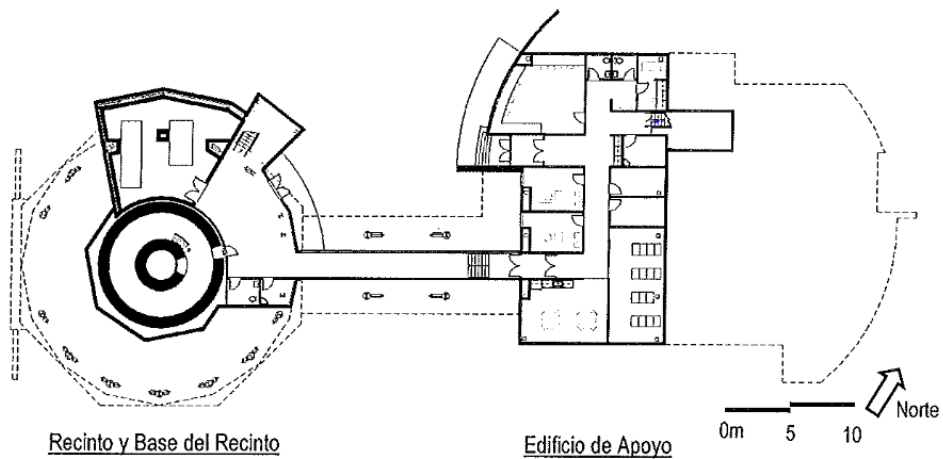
Plano de Planta General – Planta Baja
